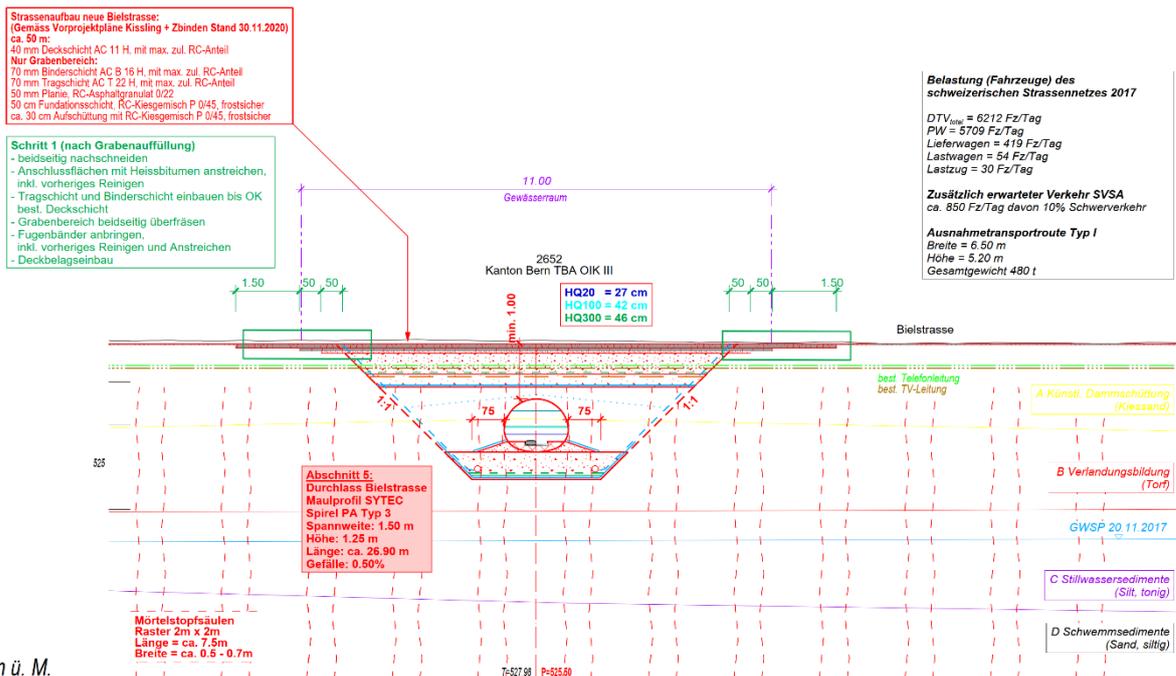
Ausschnitt Detailplan Schnitte Durchlass Bielstrasse Stand Wasserbauplan, 26.07.2024
